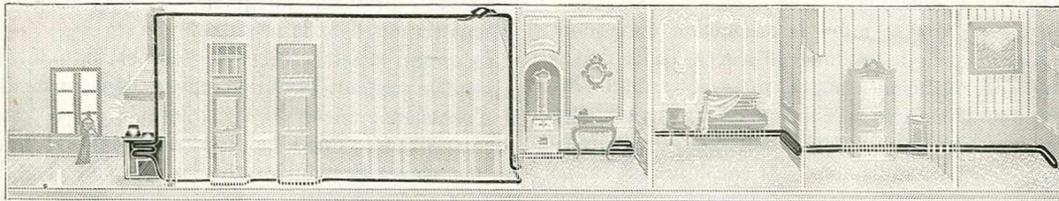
Chauffage d'un rez-de-chaussée avec appareil dans la cuisine.
